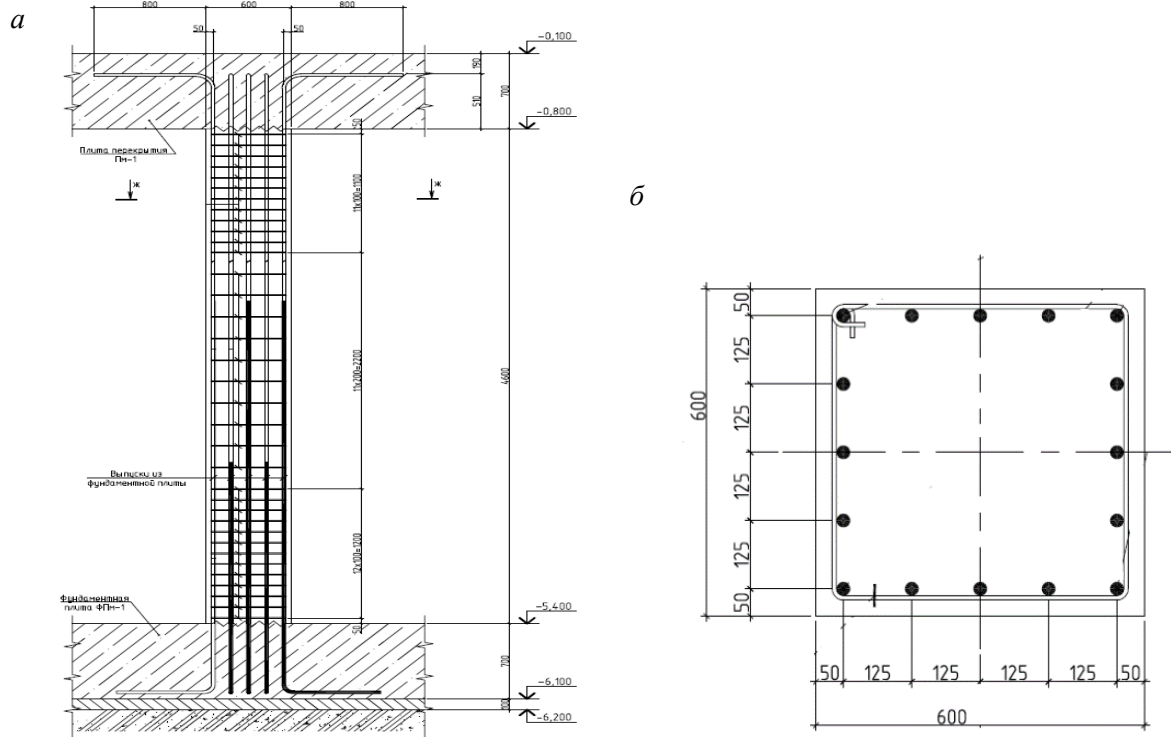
Поперечное сечение и вид сверху моделируемой железобетонной колонны:
